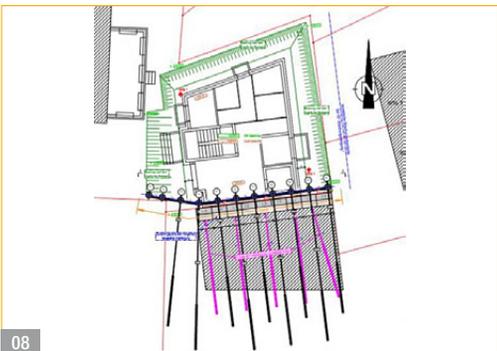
Grundriss Neubau mit geänderter Baugrubensicherung als rückverankerter Bohrpfehlwand mit Spritzbetonausfachung, o. M.
